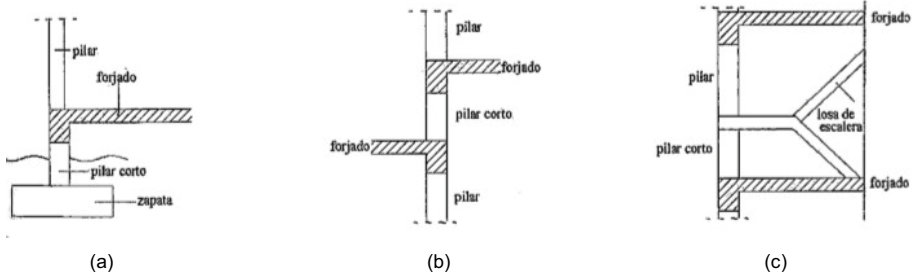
Pilares cortos en: (a) Cimentación. (b) Forjados a distinta altura. (c) Escaleras (Fuente: Benavent-Climent, 2010)
